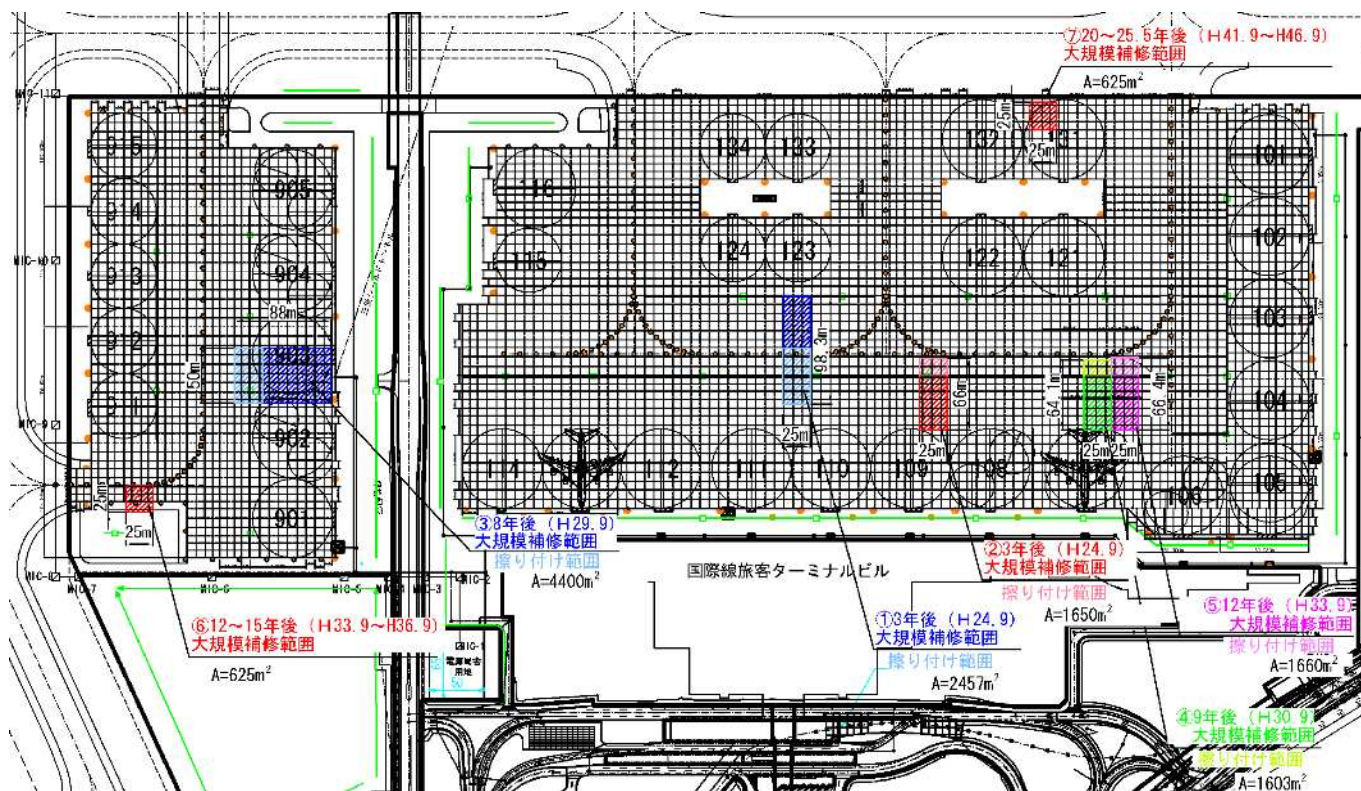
大規模補修工事設計範囲(初年度~25.5年後)平面図
